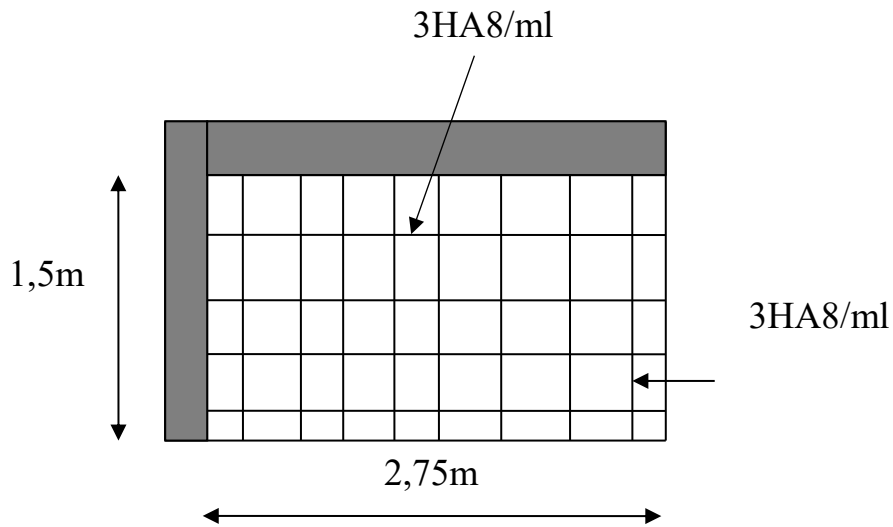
Schéma de ferrailage d'une dalle sur 2 appuis.
